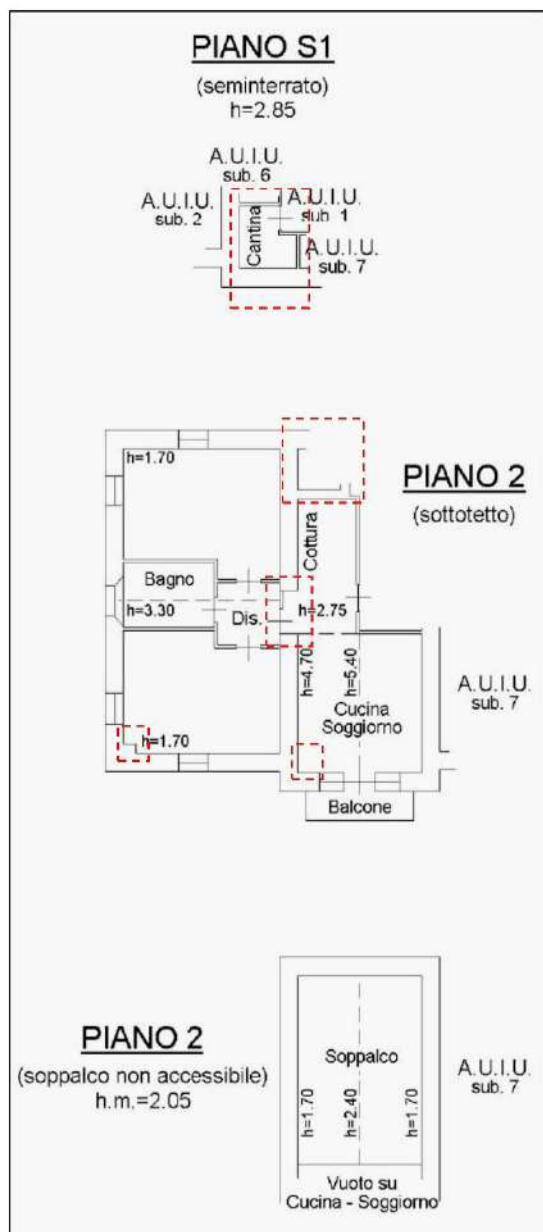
Planimetria castale Appartamento 6 con cantina (Sub. 8)
